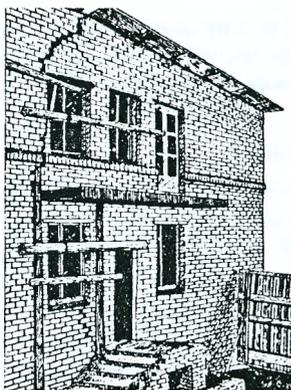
Деформация кирпичной стены здания при оттаивании промерзшего грунта под фундаментами со стороны подвала
